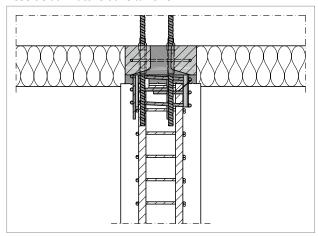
Schöck Sconnex® type P : pose de l'armature dans la zone 1 – coupe longitudinale du poteau
